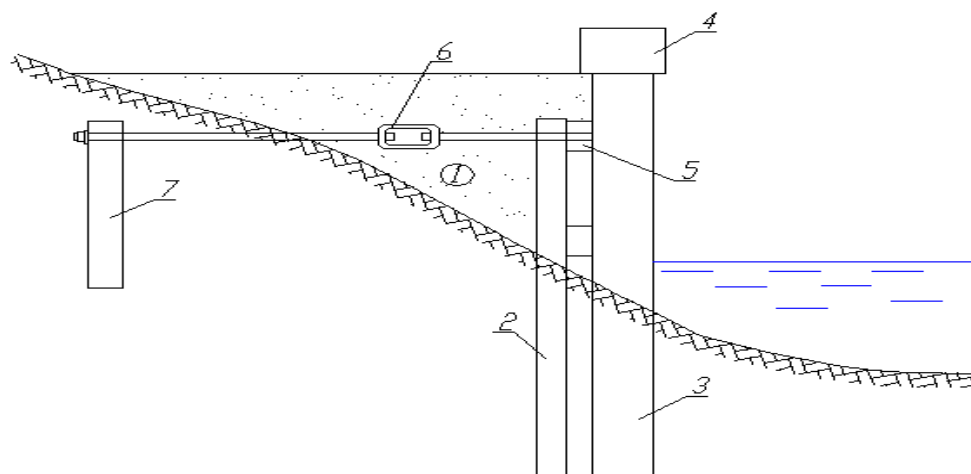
Шпунтовая стенка из шпунта ПВХ с анкерным креплением
